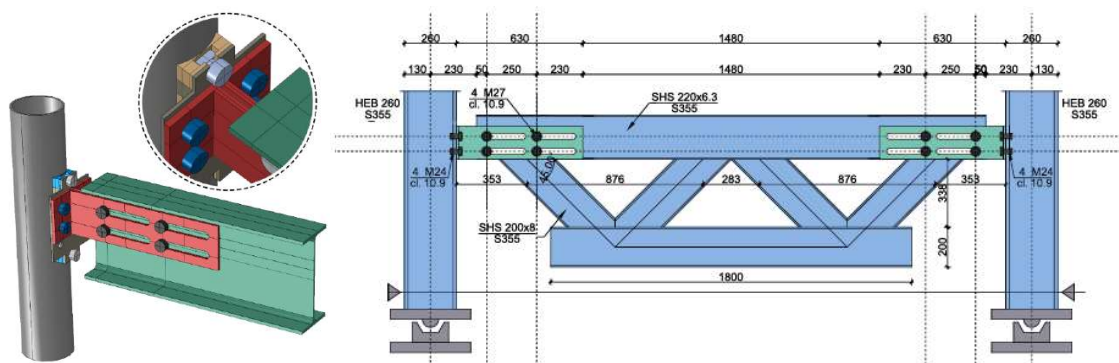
Uniones simples. a) Vigas de sección abierta y pilares tubulares, b) Celosías y pilares de sección abierta.
